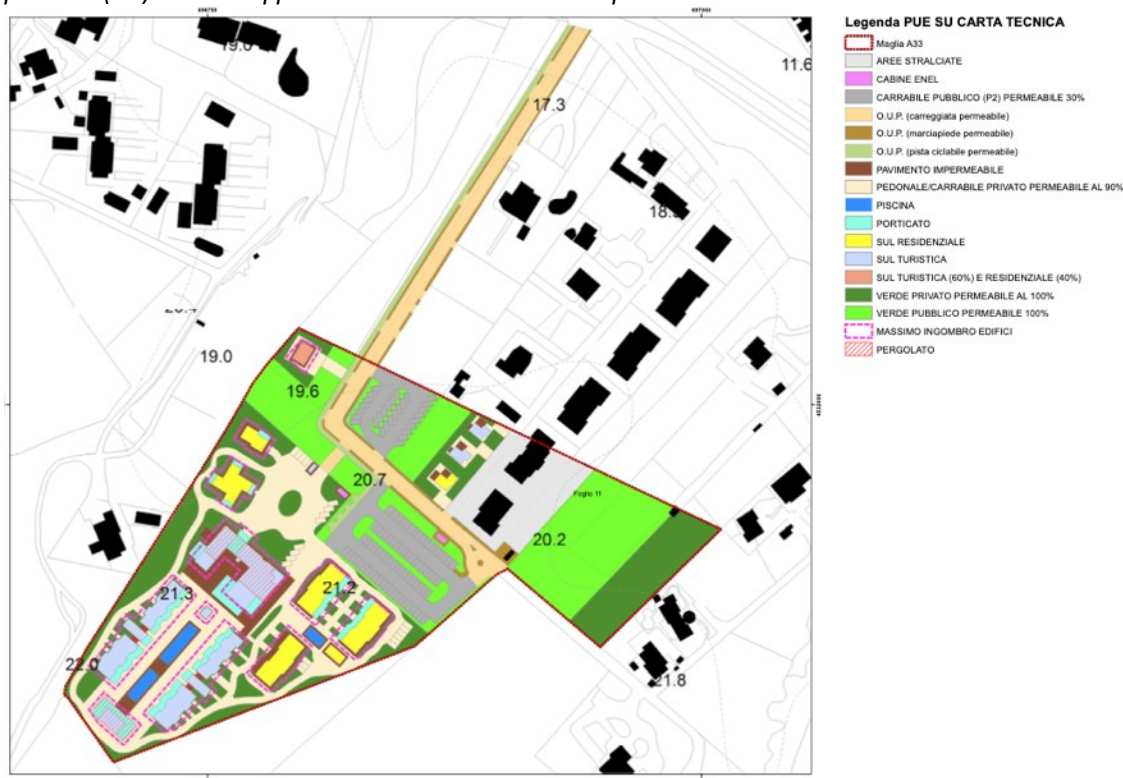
Stralcio della tav. 20 (prot. n. 9495 del 09.01.2025)
